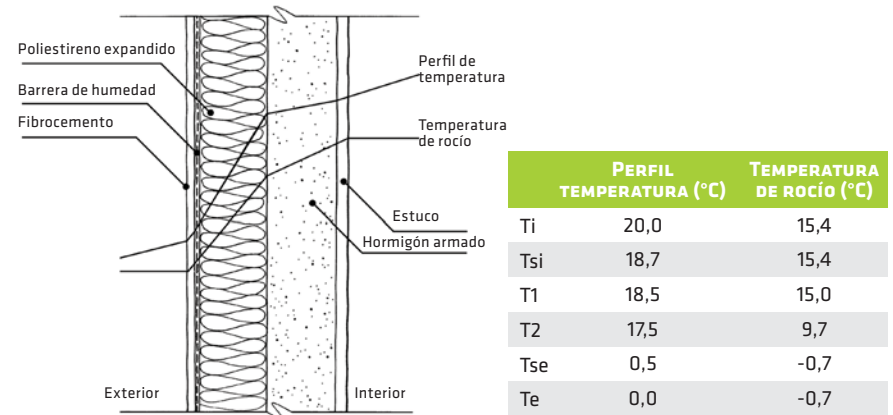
Riesgo de condensación en muro de hormigón armado aislado térmicamente por el exterior
